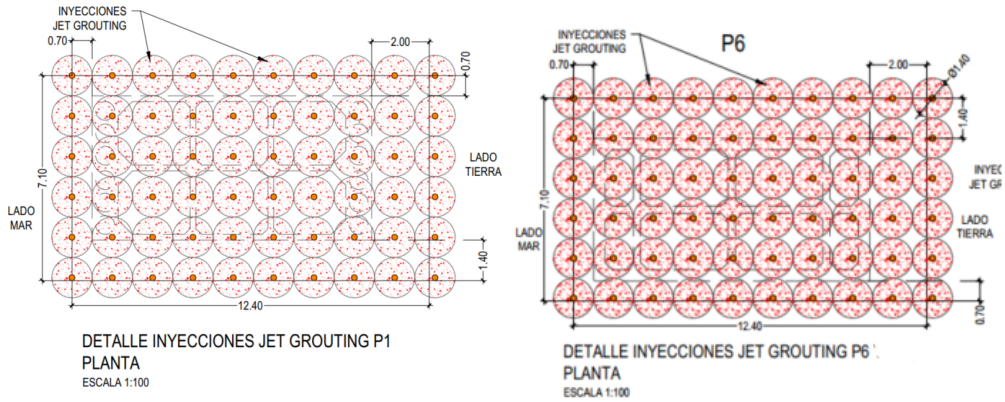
Planta de inyecciones en pila P1 y P6. Área de 12.4 x 7.1 m.
